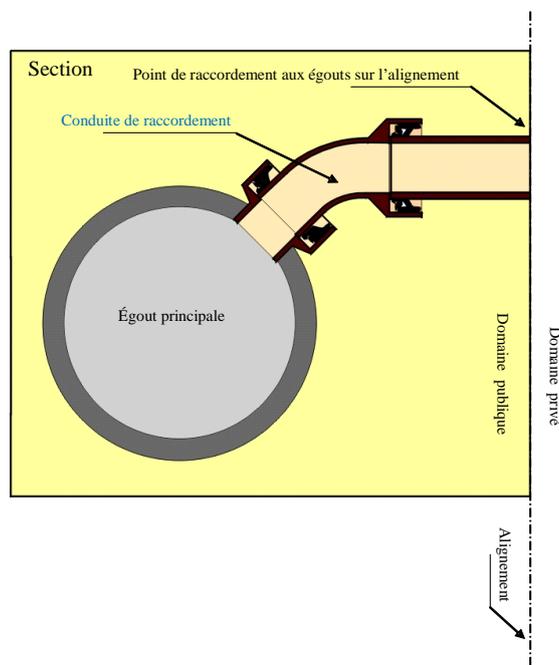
Schéma de principe du raccordement à un conduit d'égout
